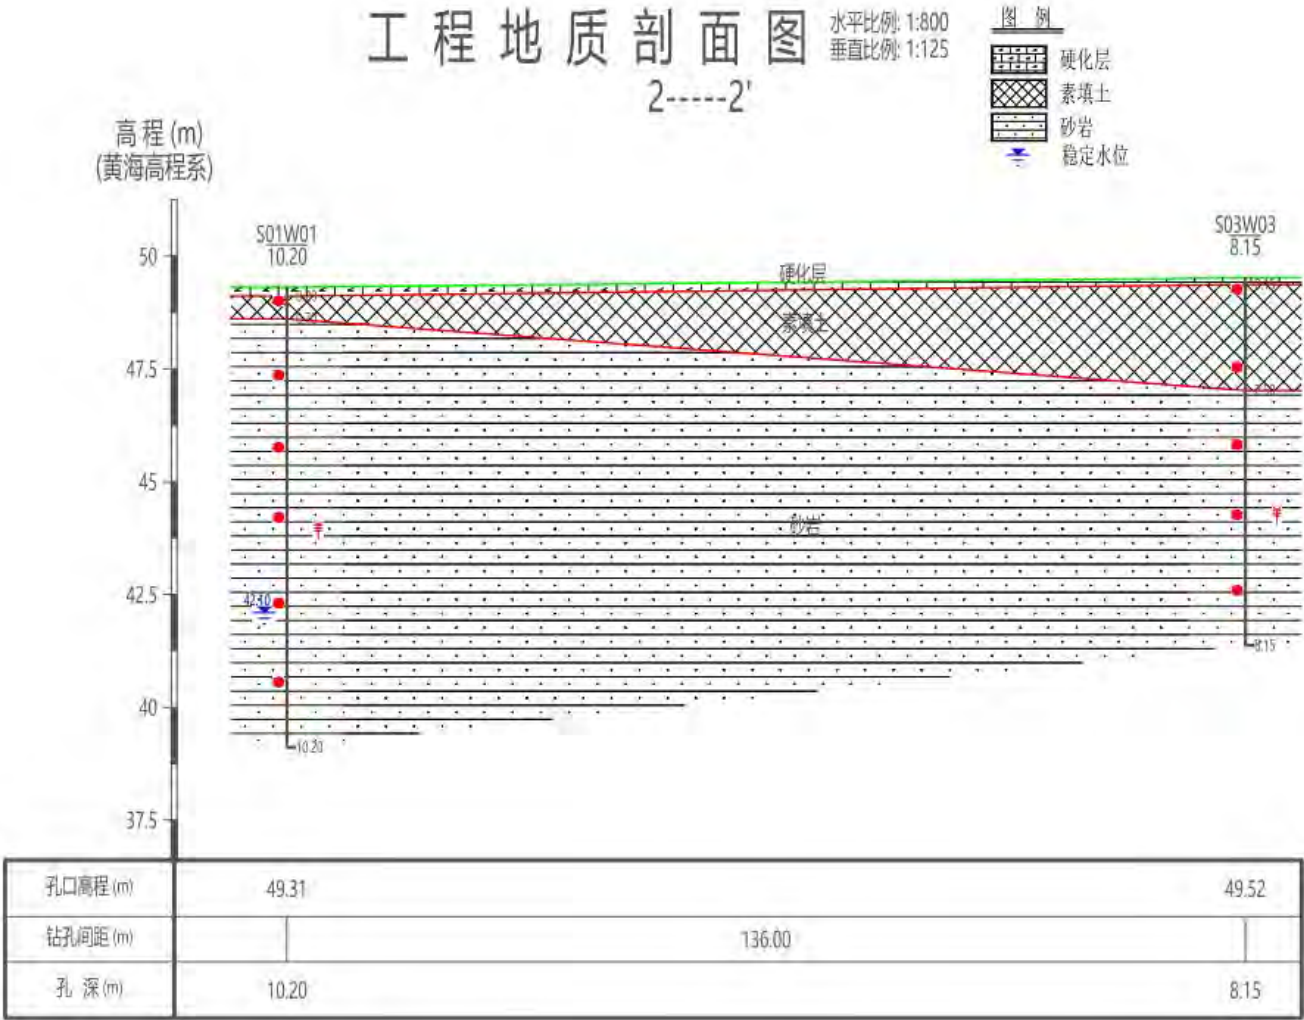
地质剖面图 (S01W01-S03W03 剖面)
